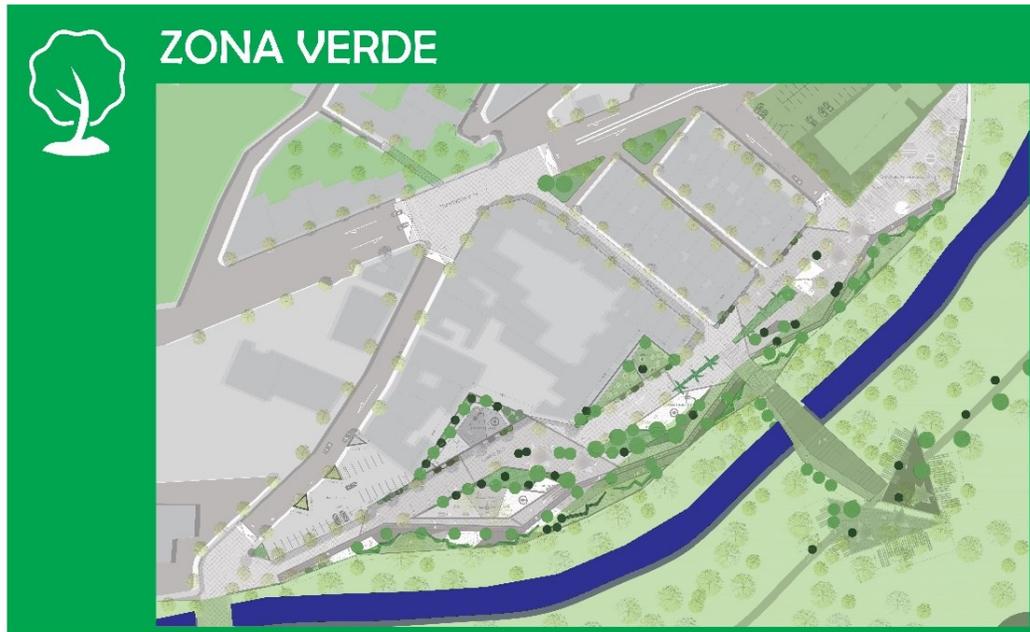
Esquema de zona verde. Fuente: Elaboración propia
